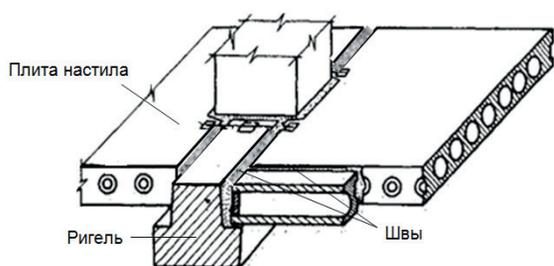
Фрагмент перекрытия связевого каркаса серии 1.020-1/83 с неорганизованными стыками плит с ригелями
